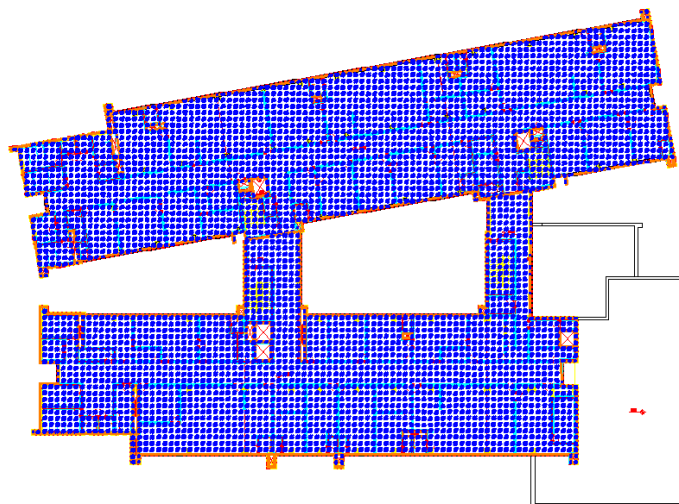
Área considerada para pavimento tipo (3º Pavimento)
